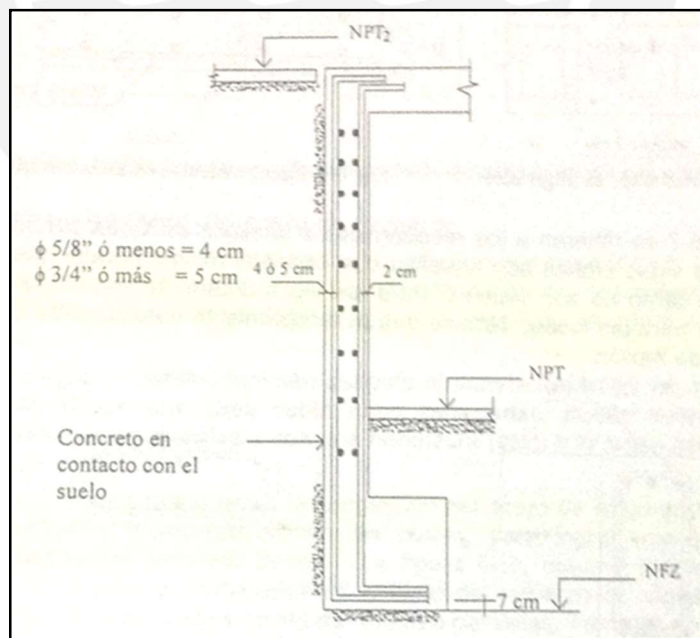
Recubrimiento en Muros. (Fuente: Apuntes del Curso Concreto Armado 1, Ottazzi 2010).
